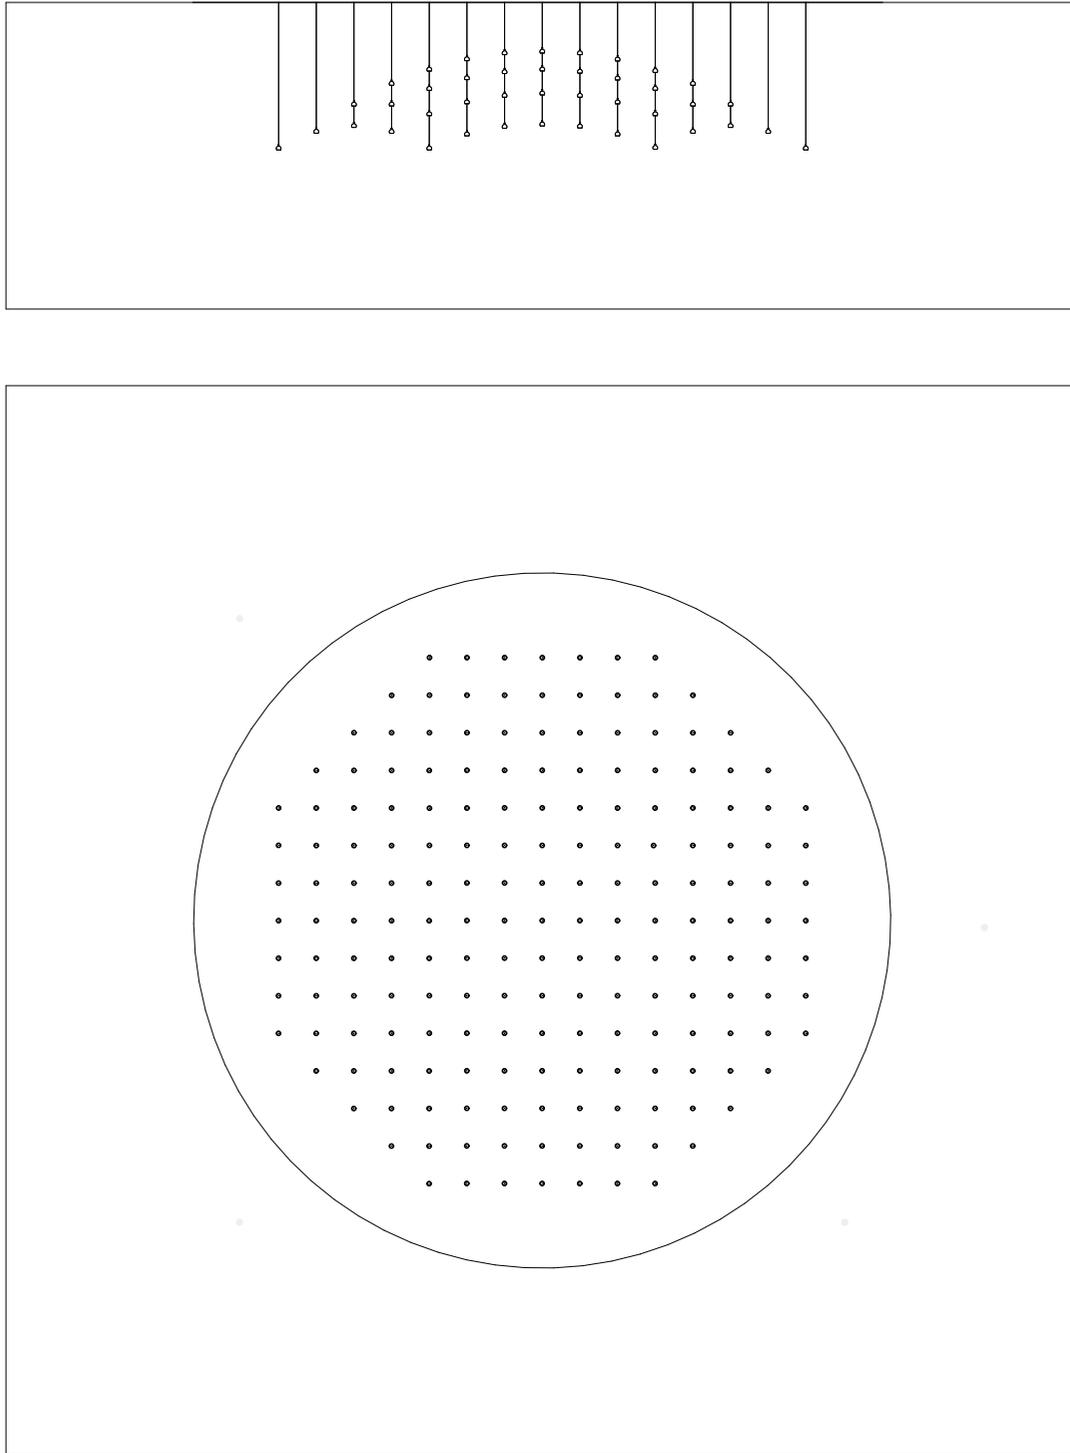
Kuppel in Grundriss und Schnitt
